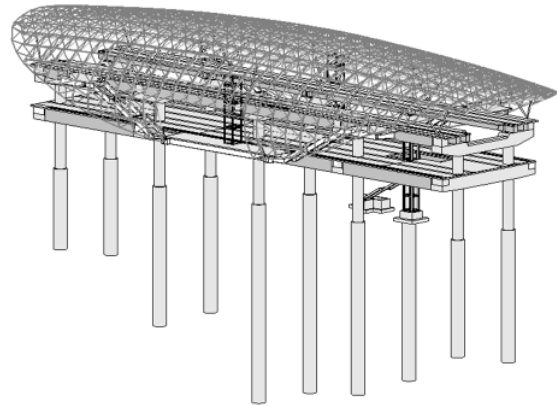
Vista en 3D de la implantación de la estación Villa Zaita
